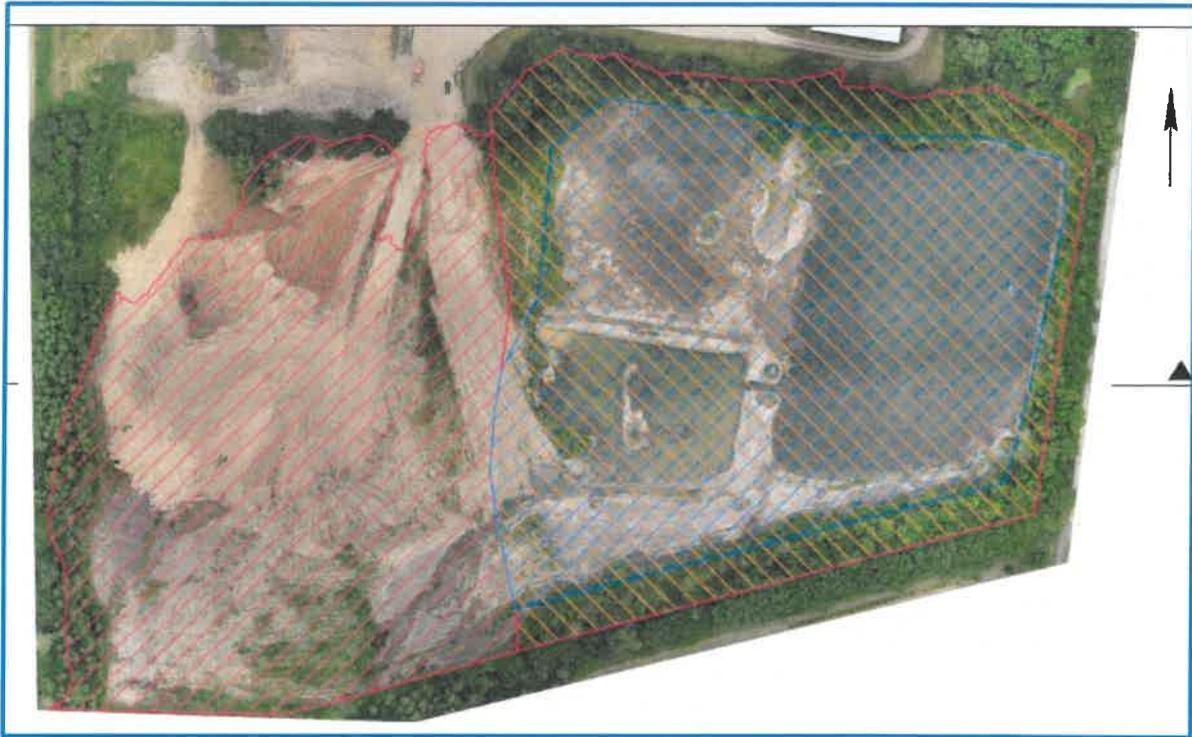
Lageplan der Tongrube Diepenau mit Darstellung der derzeitigen Verfüllung (rot schraffiert) sowie des geplanten Tonabbaus (blau schraffiert) und anschließender Verfüllung (orange schraffiert)
